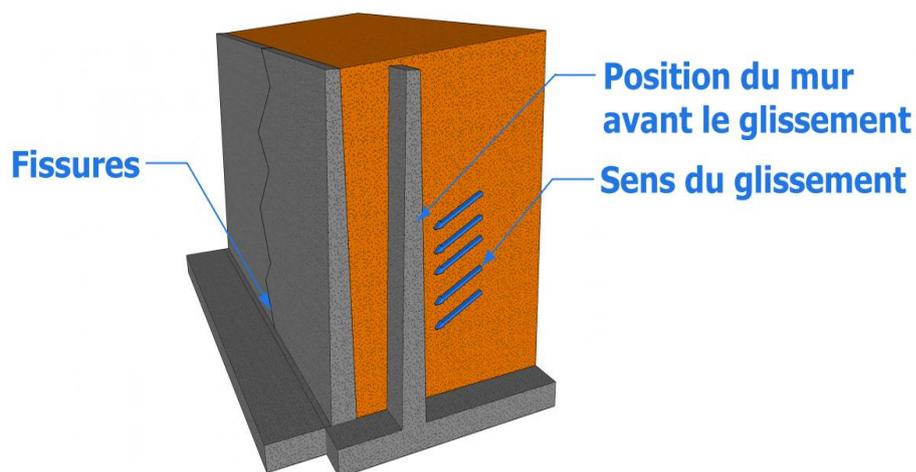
Cas de fissuration d'un mur de soutènement
